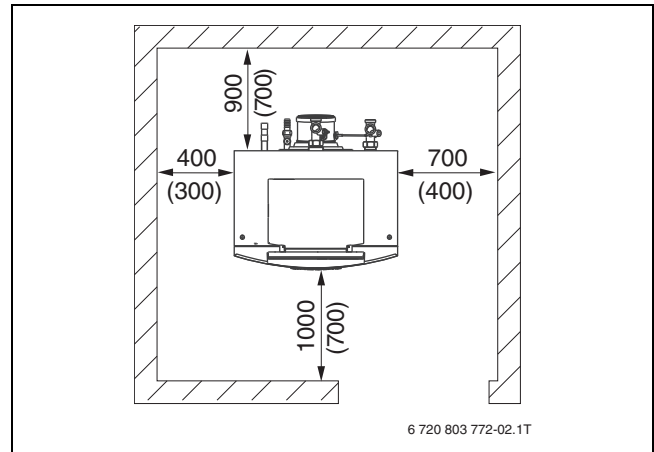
Wandabstände im Aufstellraum: Empfohlene und minimale Wandabstände (in Klammern, alle Maße in mm)
